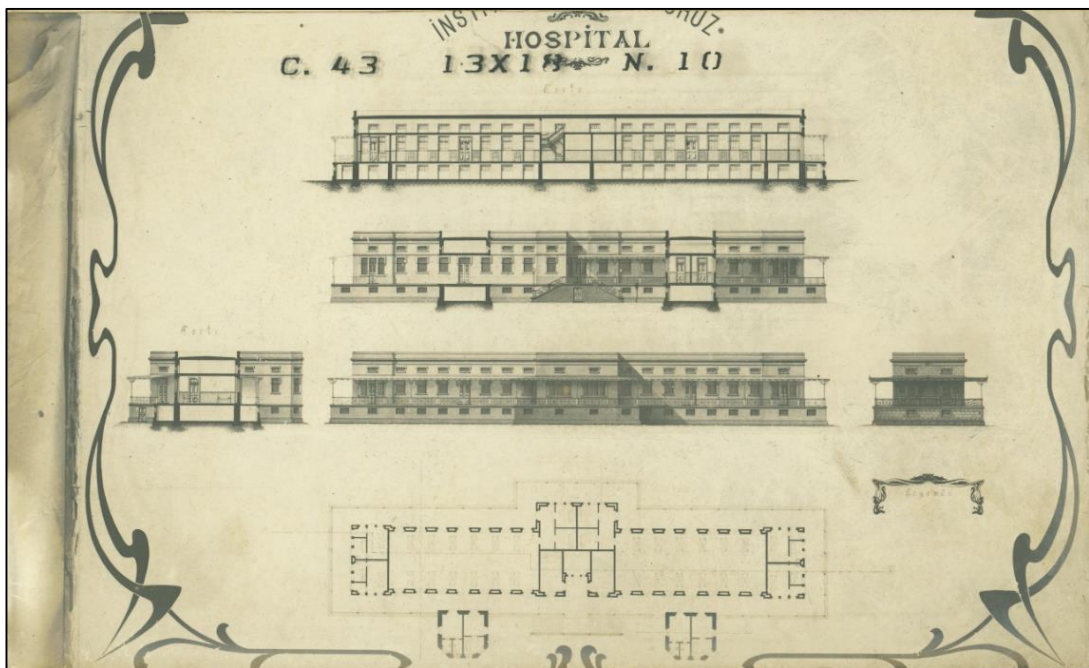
Planta do Hospital Oswaldo Cruz – 1913
